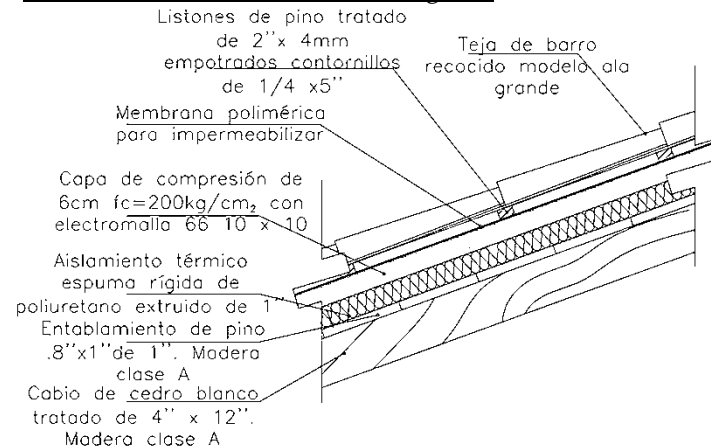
Corte por fachada Cabaña tipo 1, extracto plano ES-2.
